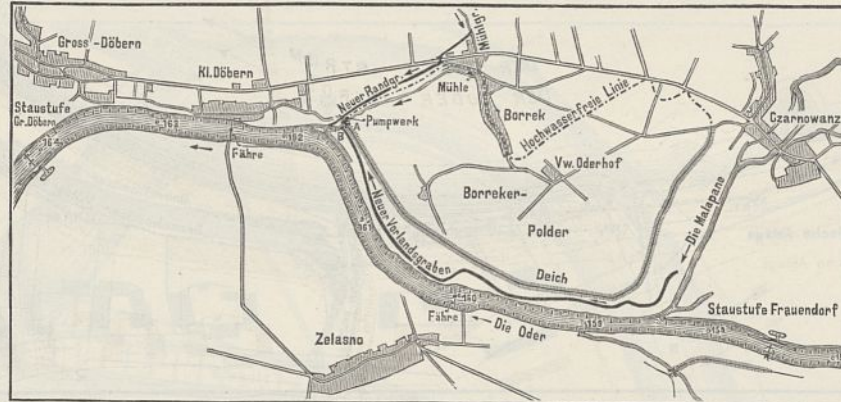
Lageplan der Entwässerung oberhalb Groß-Döbern.
